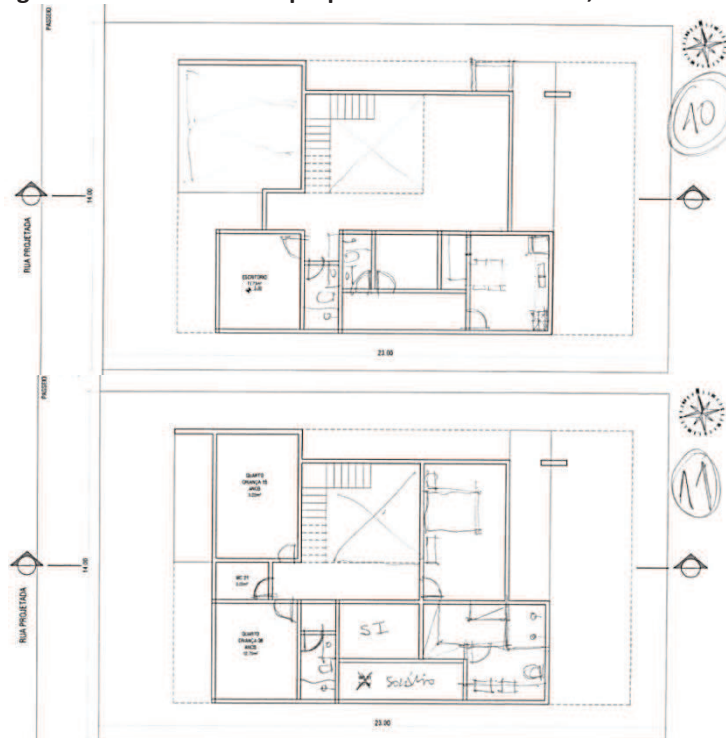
Croquis das plantas baixas – Profissional 09, Exercício 01.
